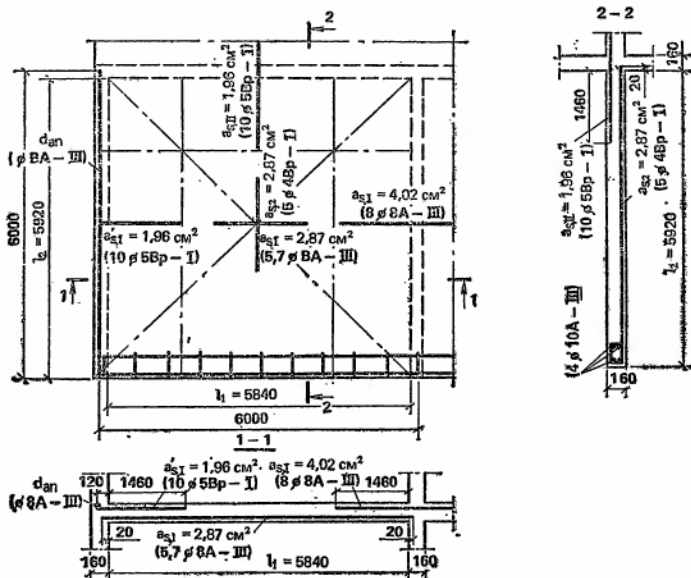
Схемы к примеру расчета монолитной плиты перекрытия
